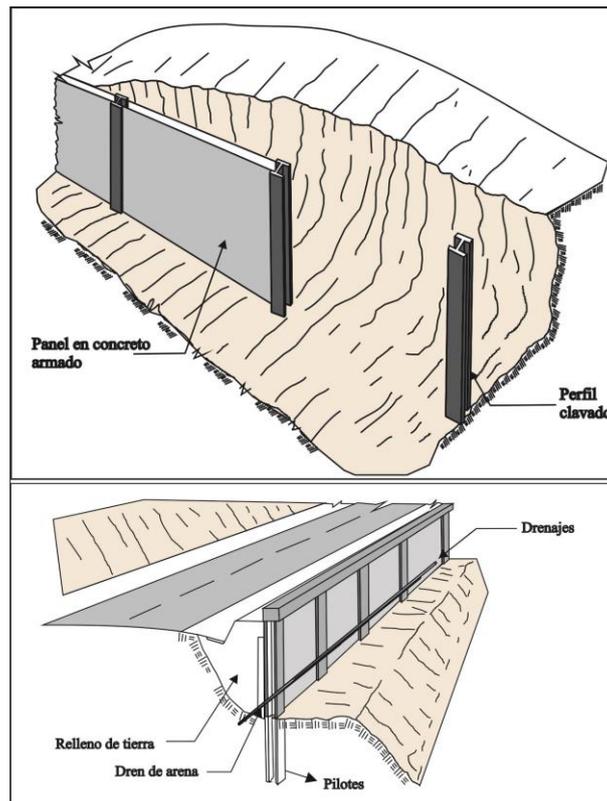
Ejemplo de muros de pantalla y muros con pilotes.
